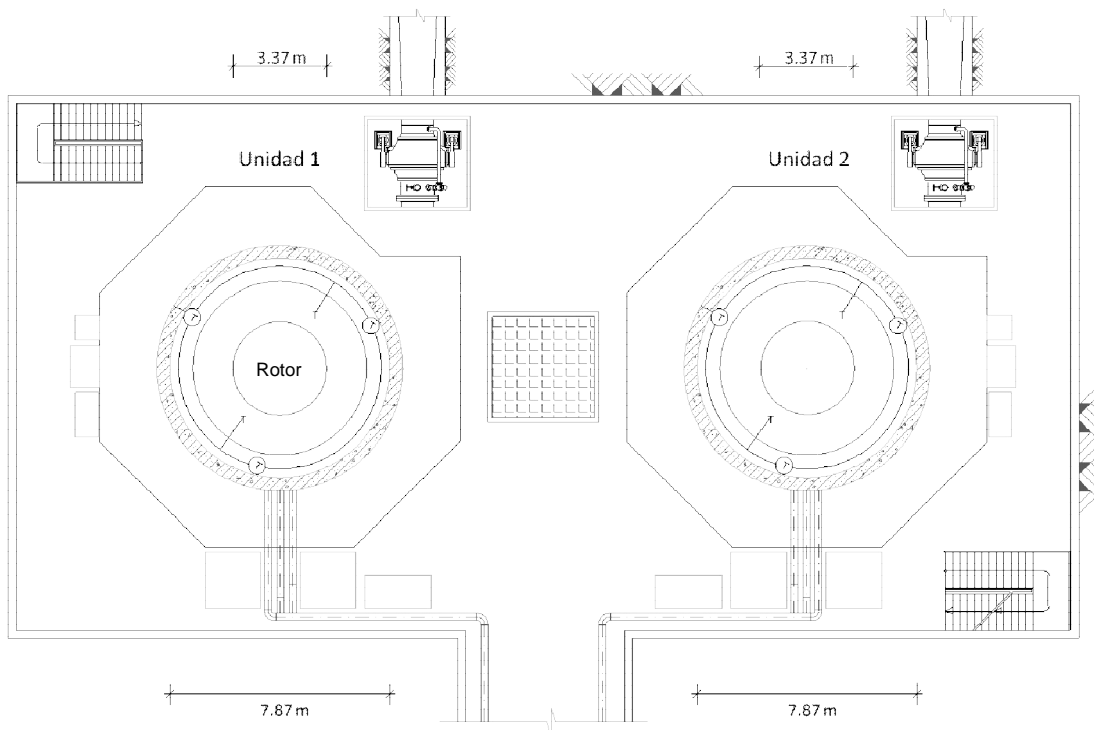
Planta piso de generadores. Elevación 287,13 msnm
